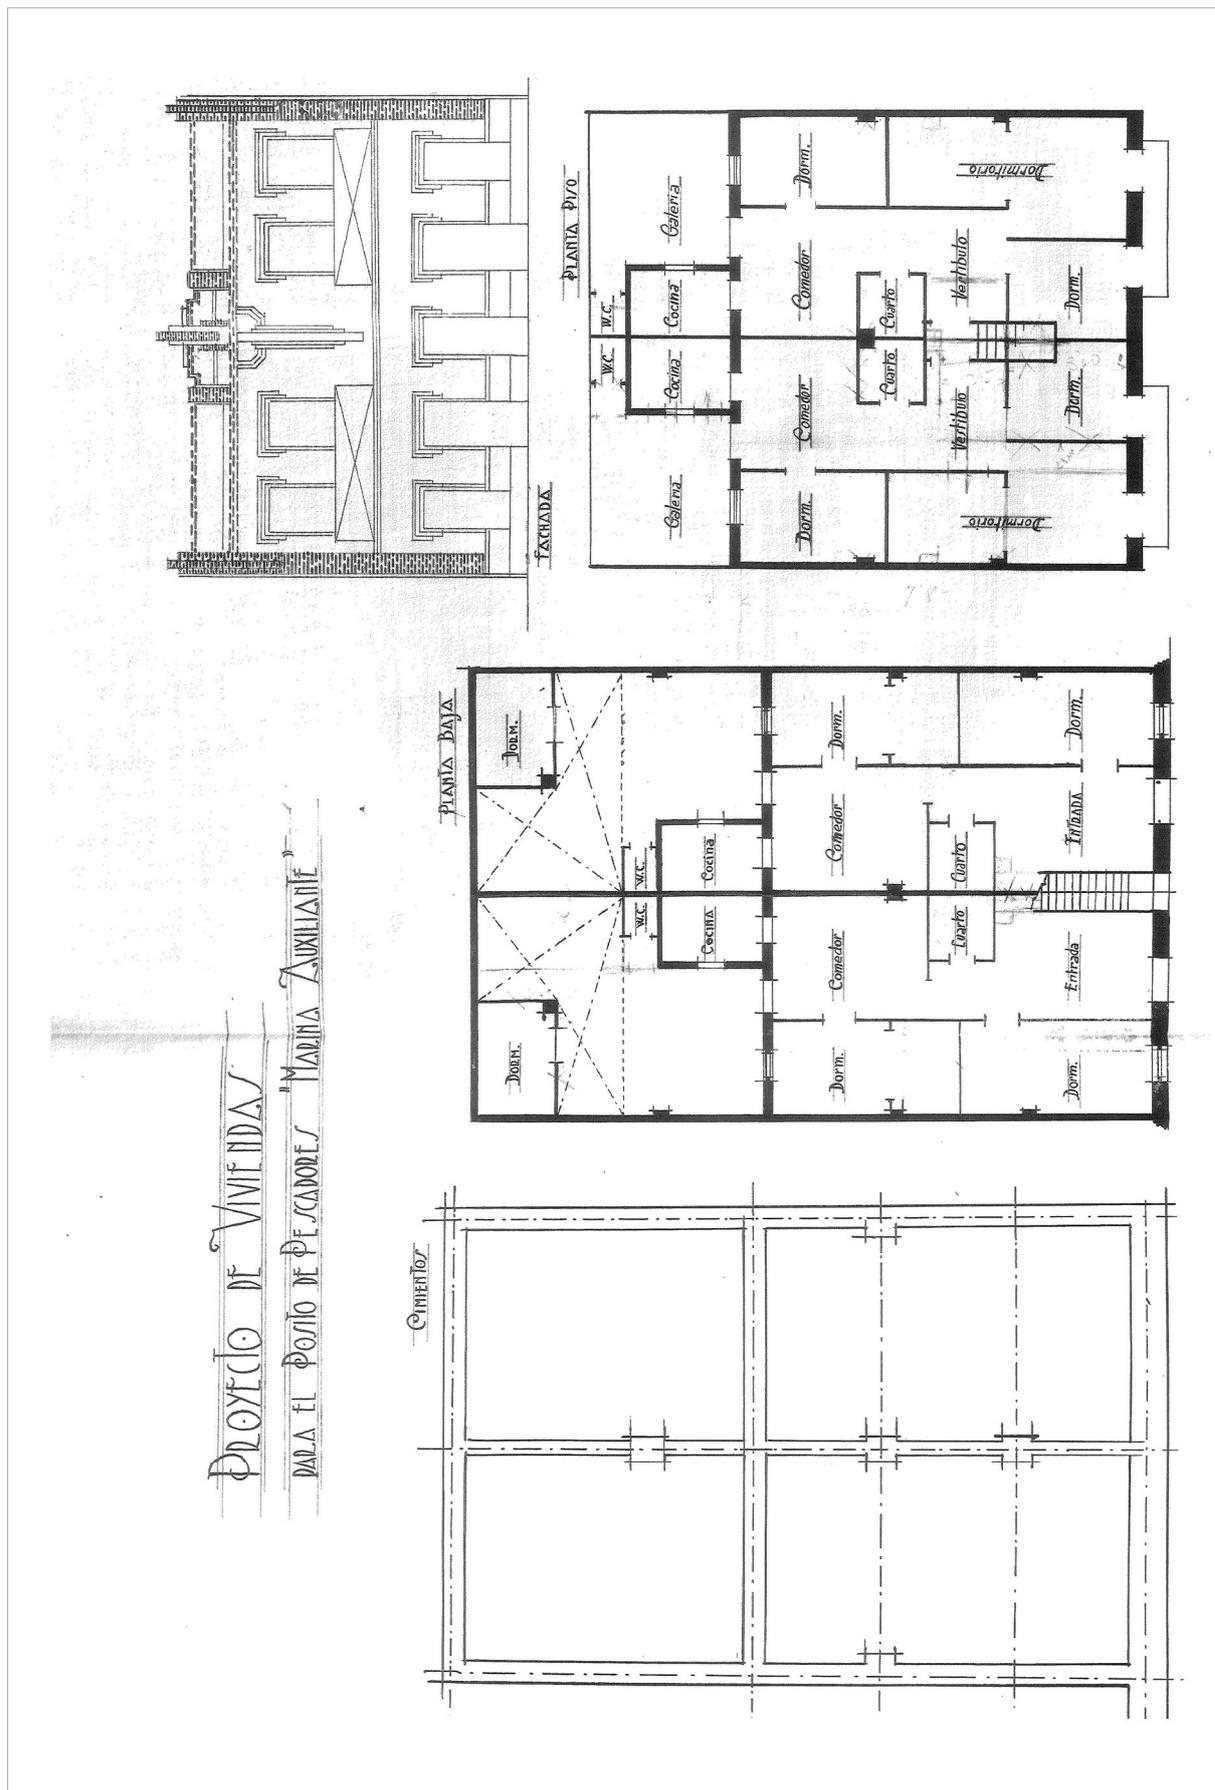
Planos de plantas, alzados y secciones, Grupo E. Fomento PU Exp. 22.726 Año 1935 Caja 8
